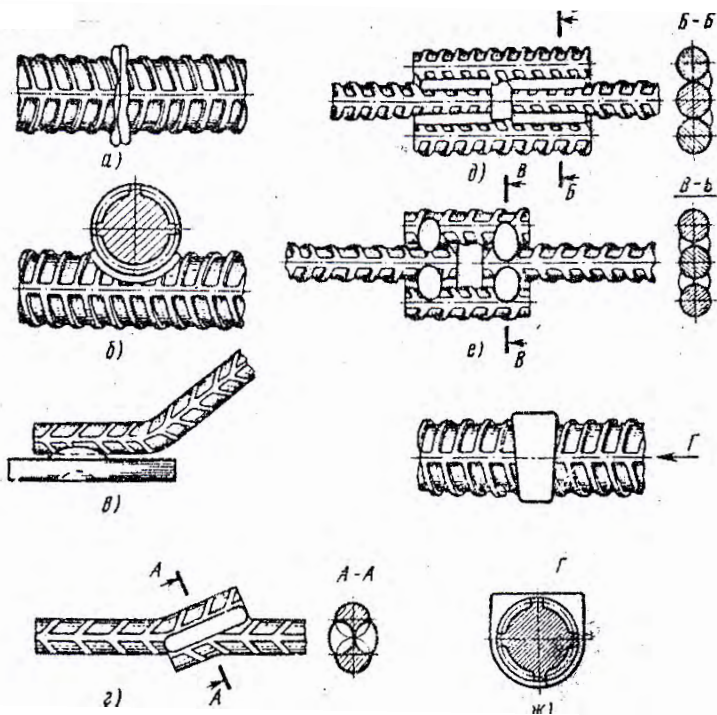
Внешний вид сварных соединений, получаемых при основных способах сварки, применяемых для стыкования арматуры: а – контактная стыковка; б – контактная точечная; в – контактная рельефно-точечная; г – дуговая шовная с нахлесткой стержней; д – дуговая шовная с накладками; е – дуговая точечная с накладками; ж – ванная
